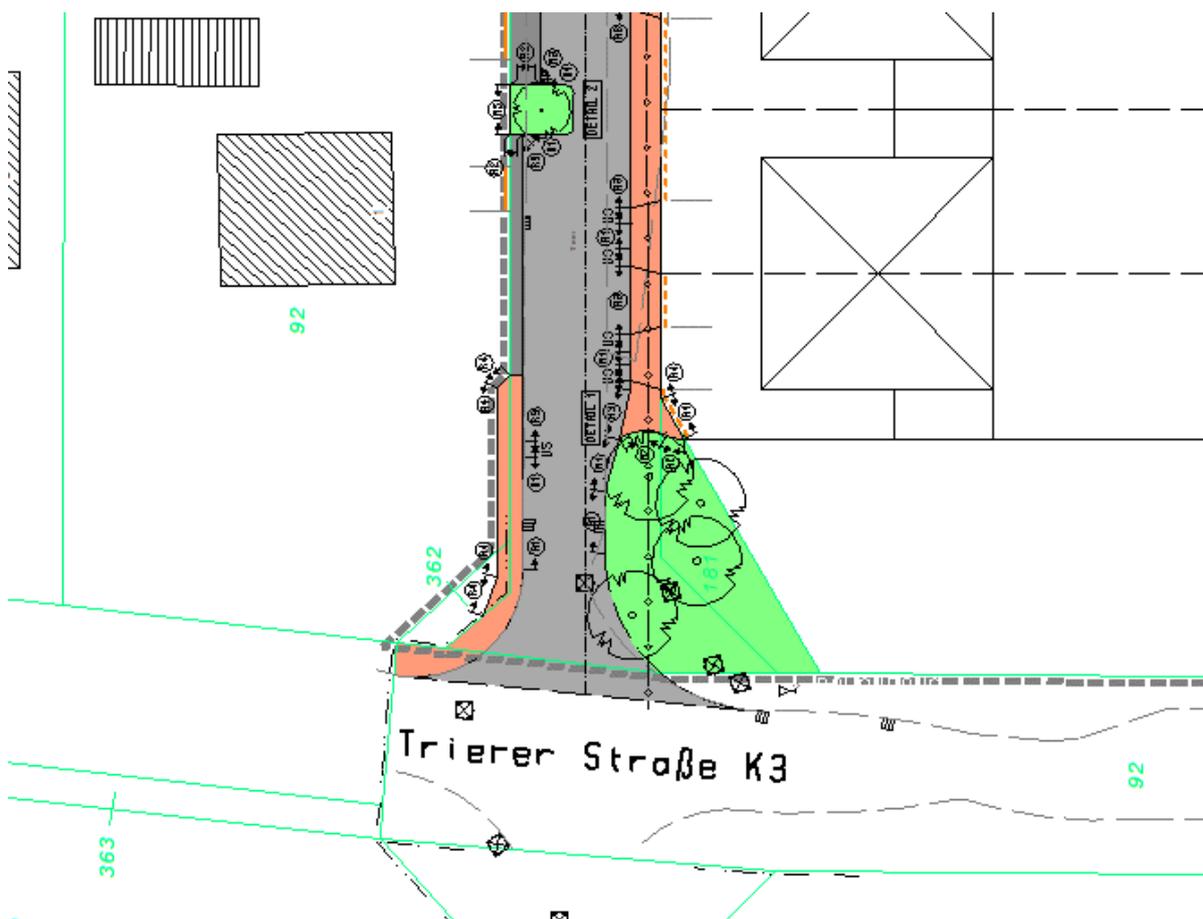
Lageplan Einmündung – Ausbauvorschlag, ohne Maßstab
